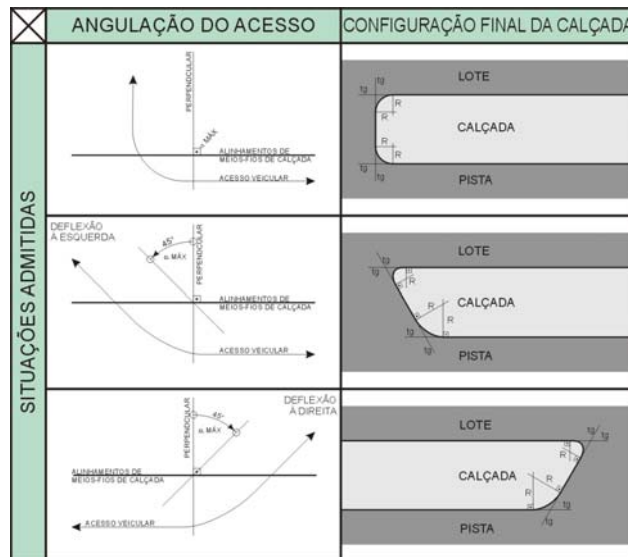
Esquema de configuração da geometria das calçadas (angulação).
